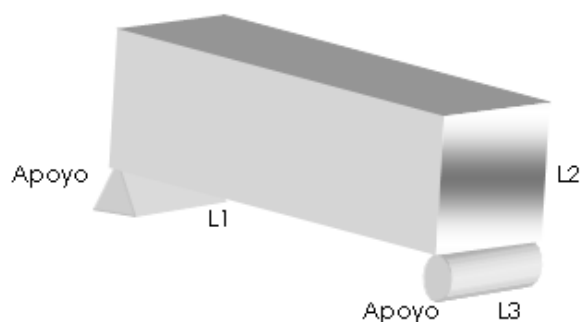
Representación tridimensional de una viga simplemente apoyada.
